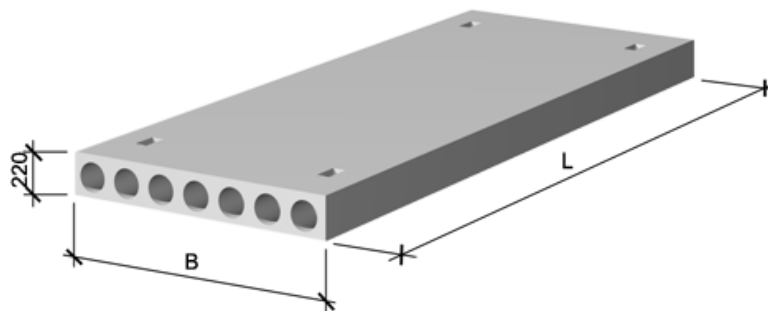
Плиты перекрытий железобетонные многопустотные для зданий и сооружений
